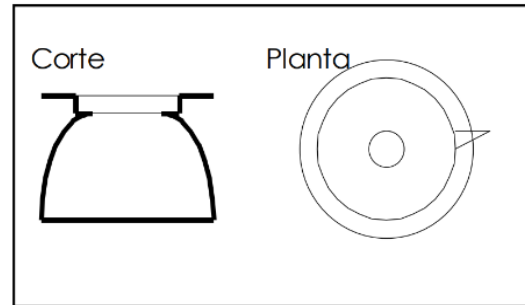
Planta y alzado de tipología de vivienda circular excavada en China (Lubes 1985, p.20, en Simancas 2003)
